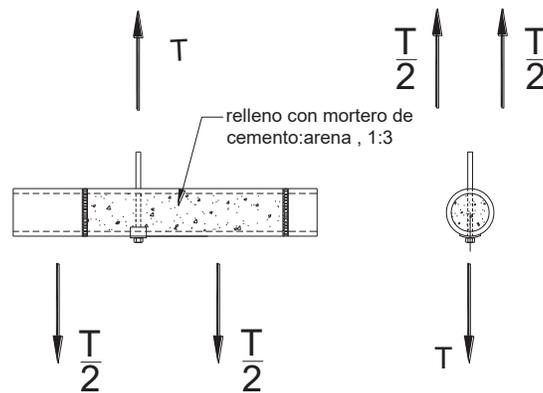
Unión de bambú con cargas a compresión perpendiculares a la fibra, tipo T.
